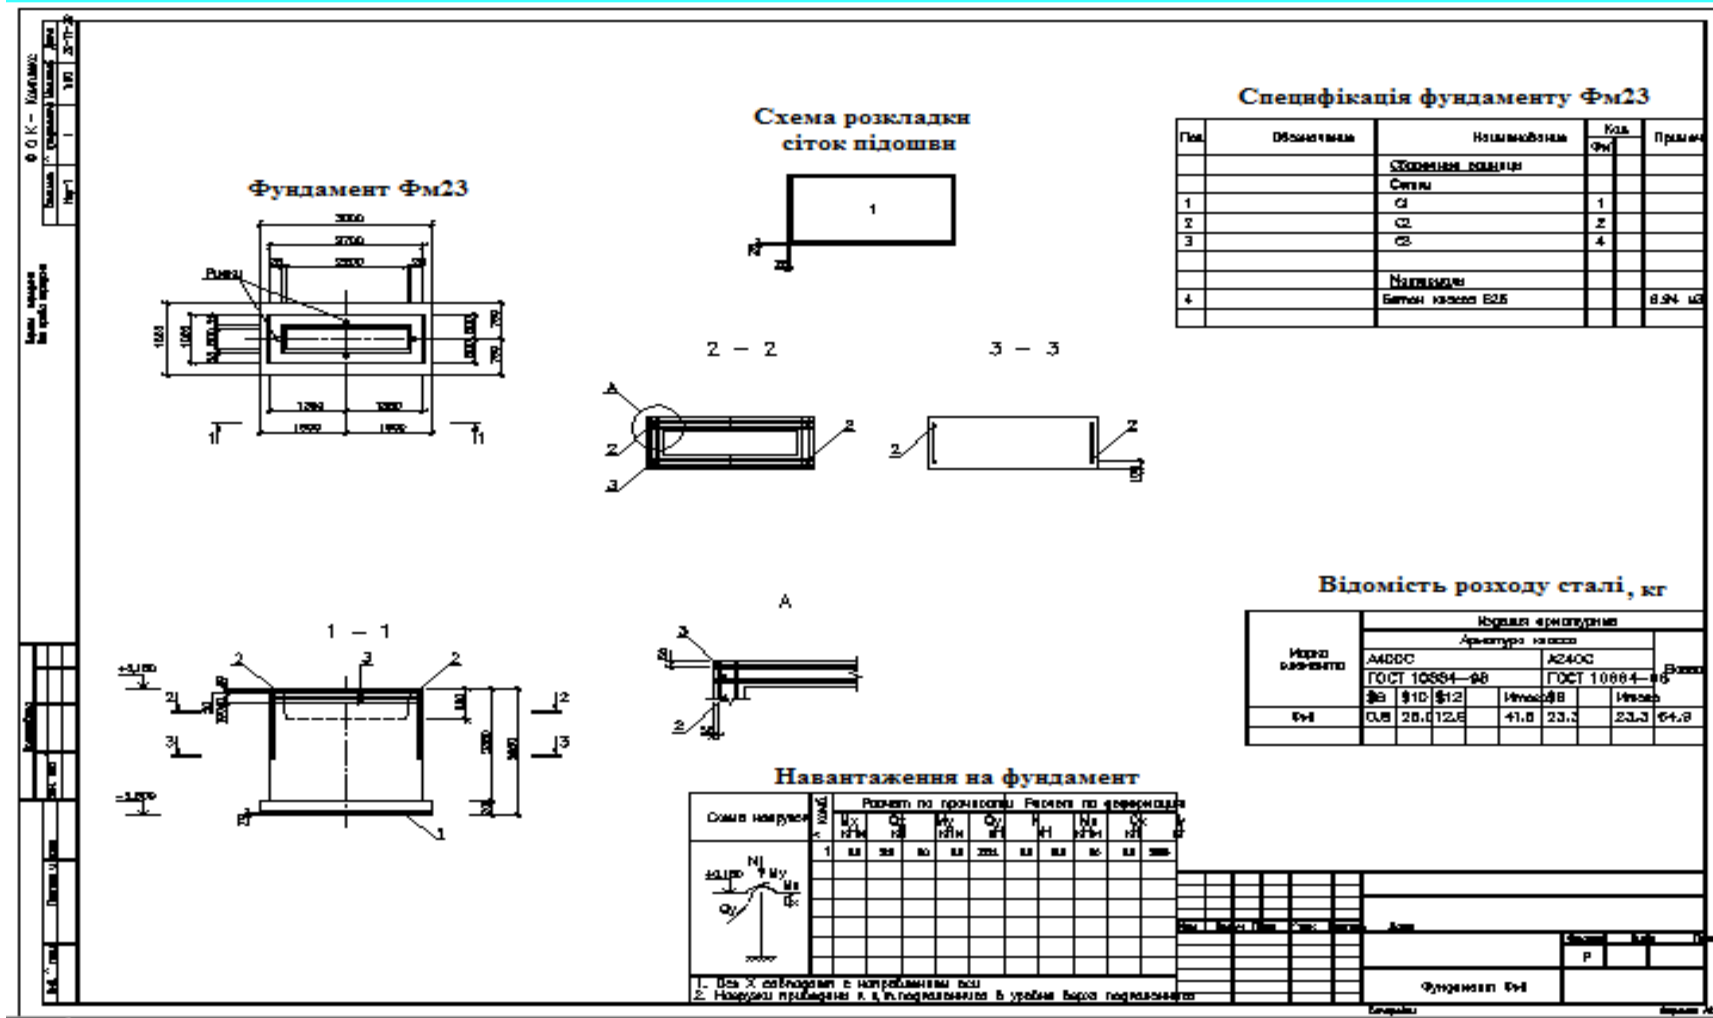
Фундамент ФМ23. Опалубкове креслення робочого проєкту
